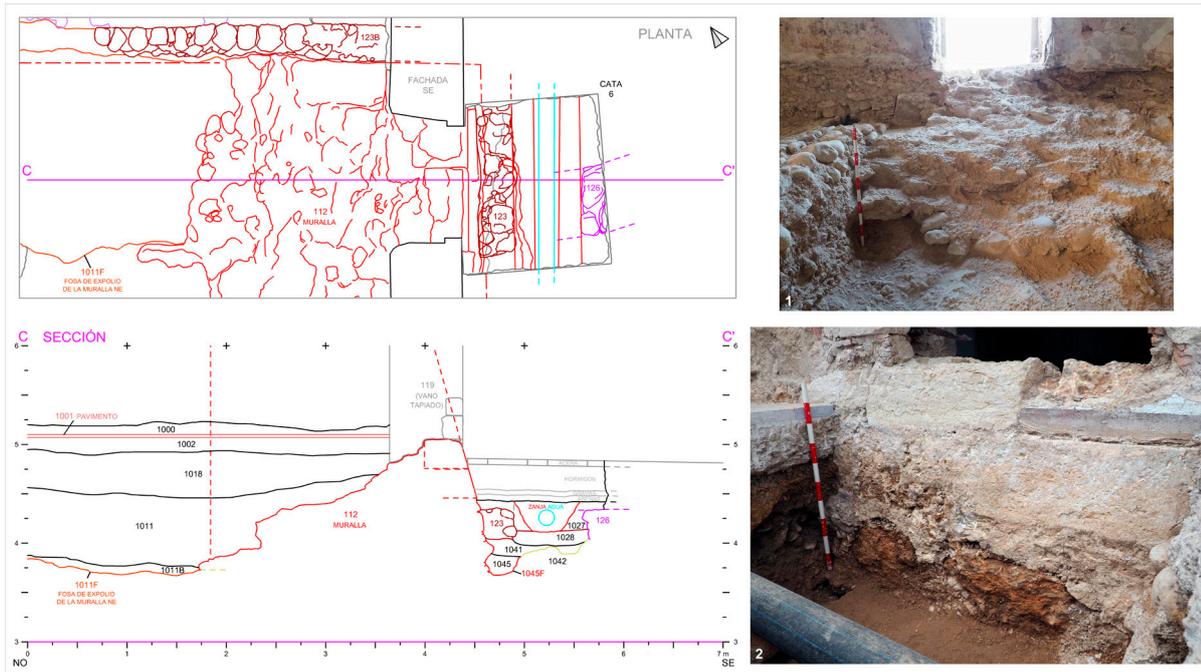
Planta y sección transversal de la muralla sureste en la esquina oriental del reducto; con vistas de su cara expoliada desde el interior (1) y el lienzo de sillería ataludado al exterior (2).
